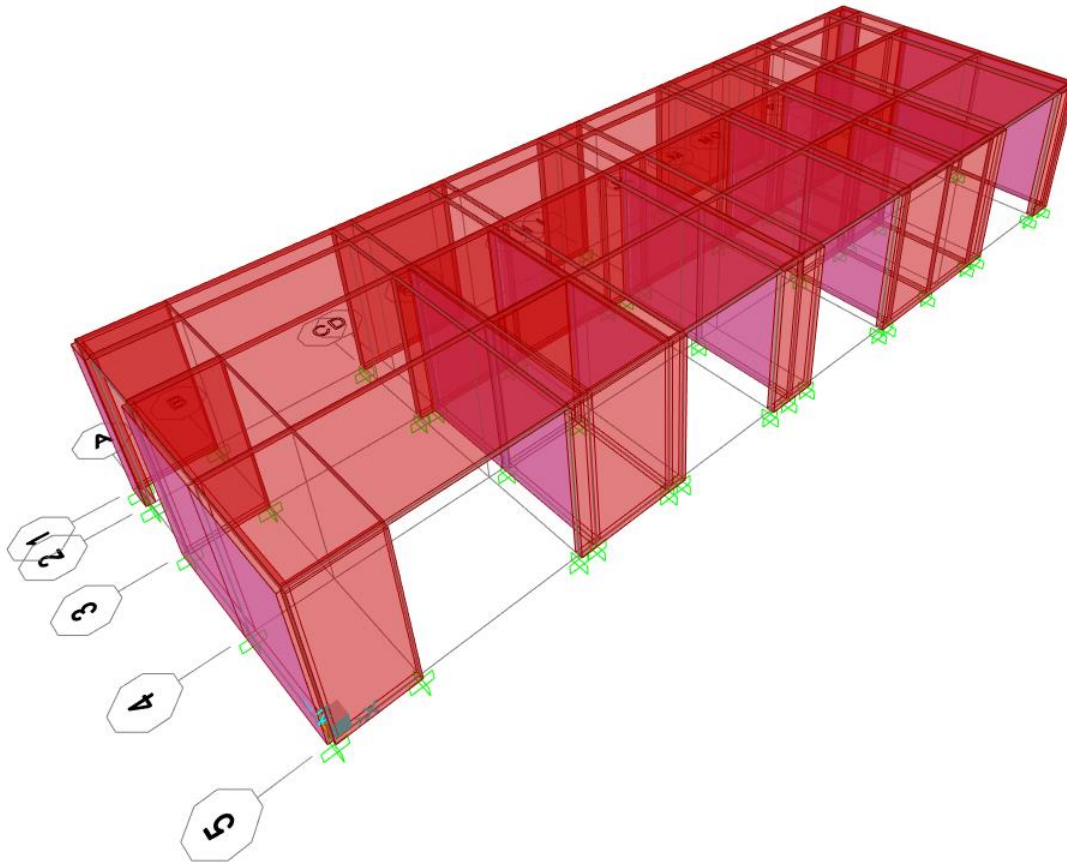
Vista 3D del modelo de vivienda tipo II Paneles SIP.
